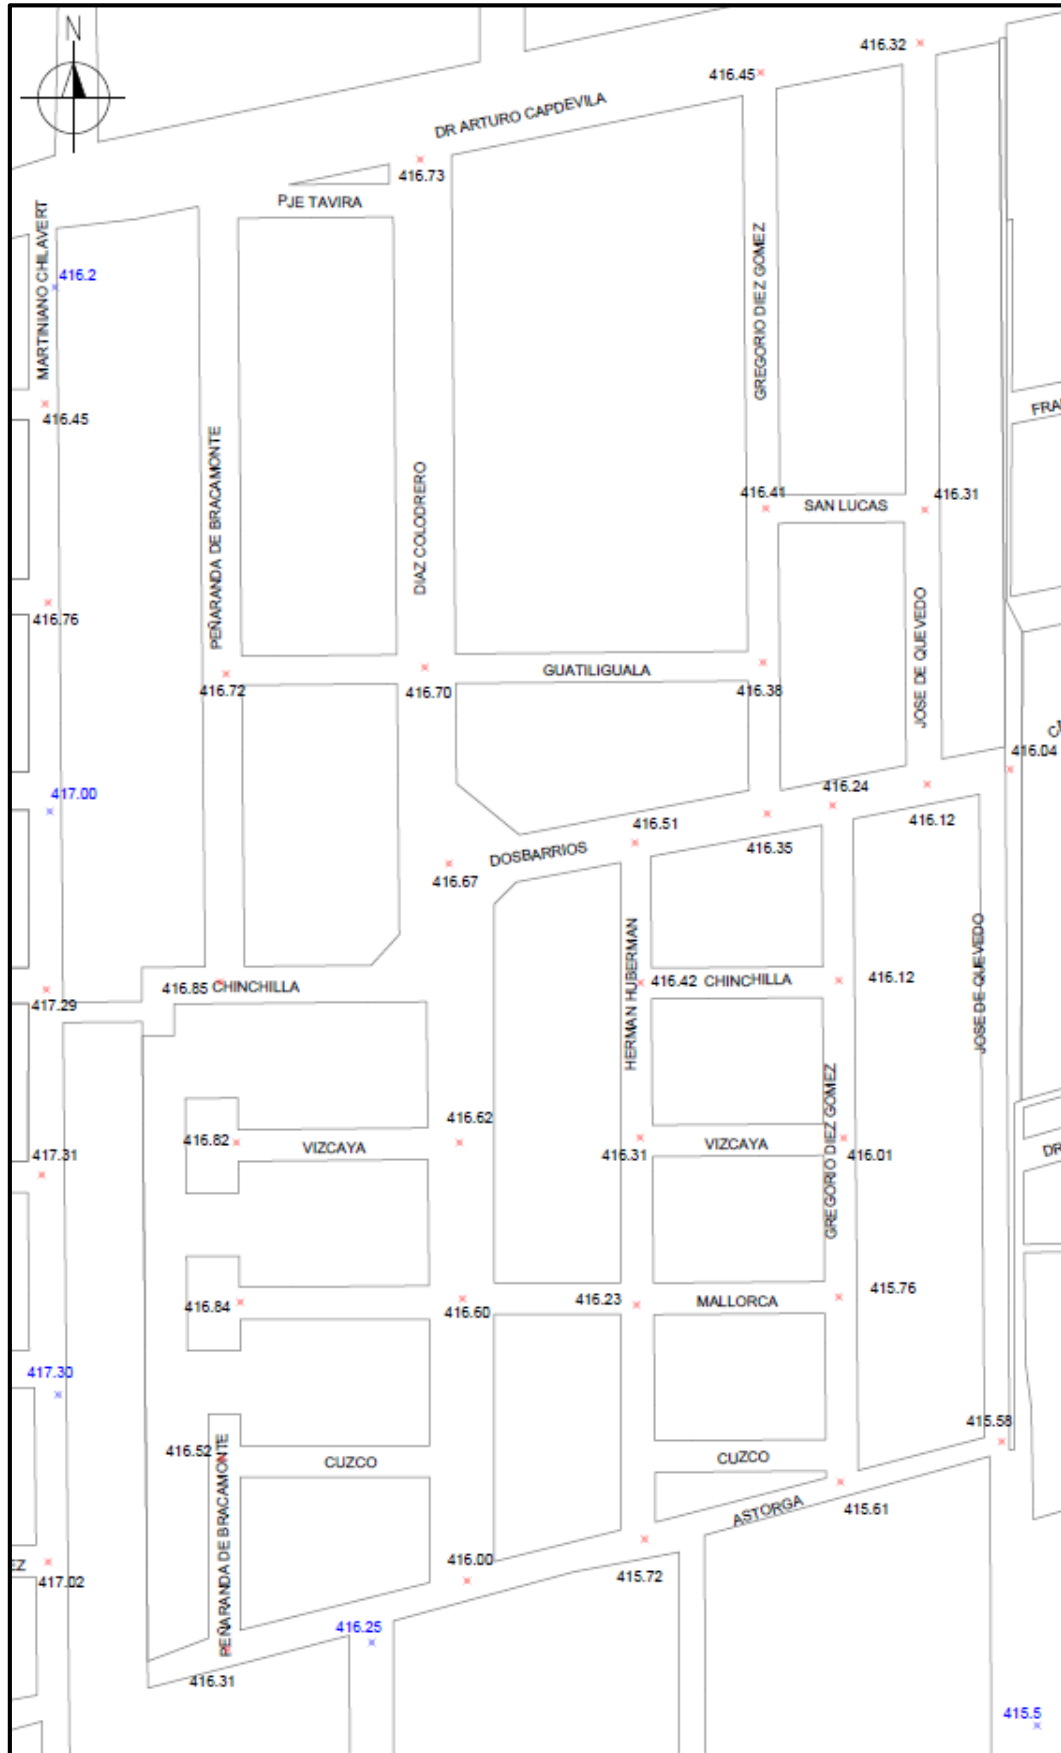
Plano puntos fijos y cotas de nivel, barrio Vivero Norte
